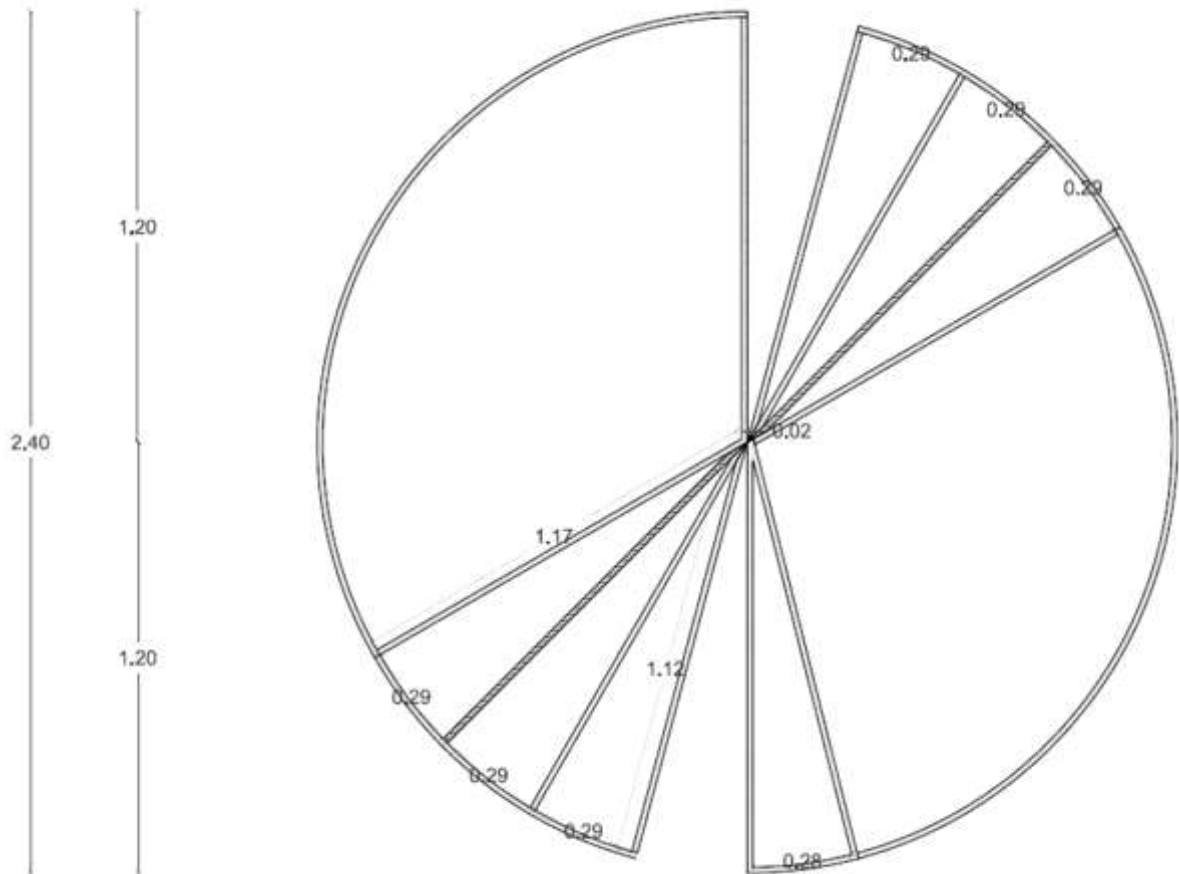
Dispositivo 3. Sumidero Sonar. Planta 1
